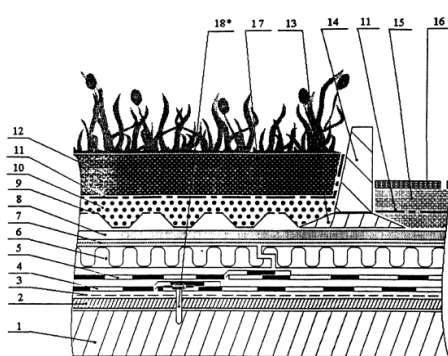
Устройство «сада на крыше» с применением системы Floradrain эксплуатируемая кровля (инверсионный вариант): 1. бетонное основание; 2. выравнивающая цементная стяжка; 3. праймер PRIMER SI; 4. нижний слой гидроизоляционного ковра из материала DERBIGUM; 5. верхний слой гидроизоляционного ковра из материала DERBIGUM; 6. утеплитель с закрытыми порами (экструзионный пенополистирол); 7. полиэтиленовая пленка; 8. геотекстиль (мат); 9. сотовый элемент FLORADRAIN; 10. керамзитовый гравий мелкой фракции; 11. геотекстиль; 12. засыпка земляным растительным слоем; 13. бетонная подушка под бордюрный камень; 14. бордюрный камень; 15. гравий фракции 5 - 20; 16. бетонная плитка; 17. зеленые насаждения.
